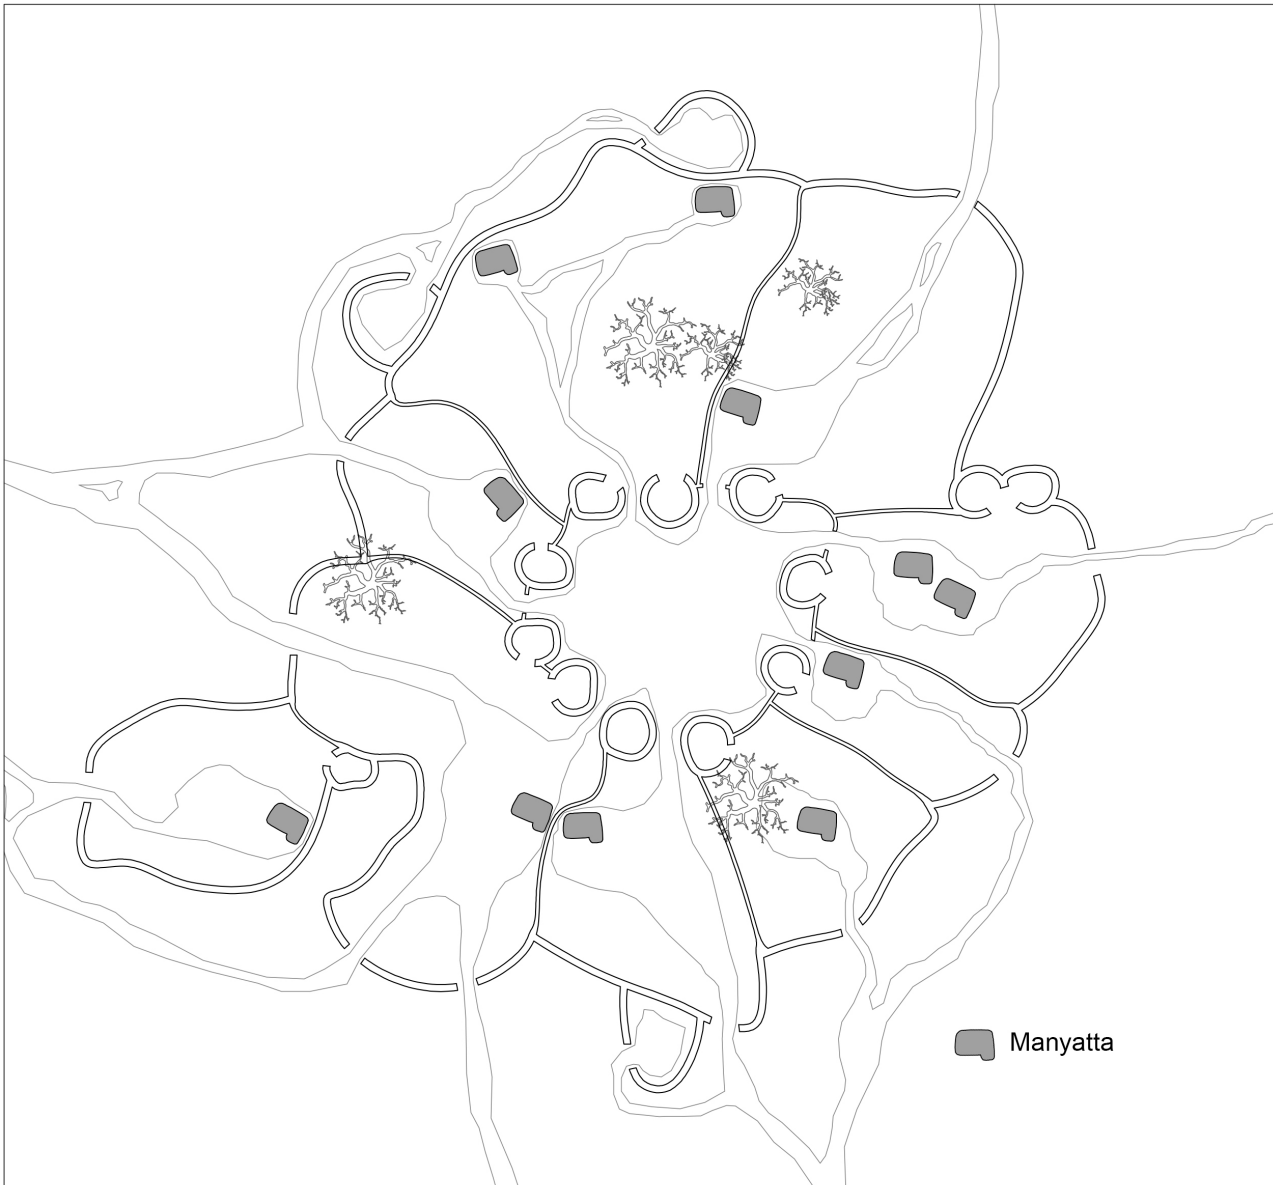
(Plano de elaboración propia). Planta de un asentamiento maasai tipo.
